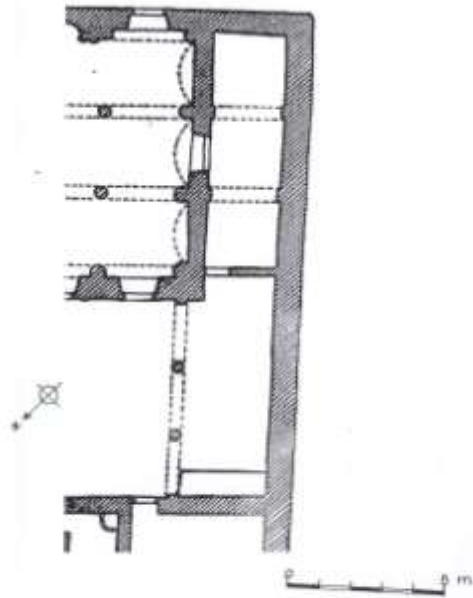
المسقط الأفقي لزاوية مسجد السور
